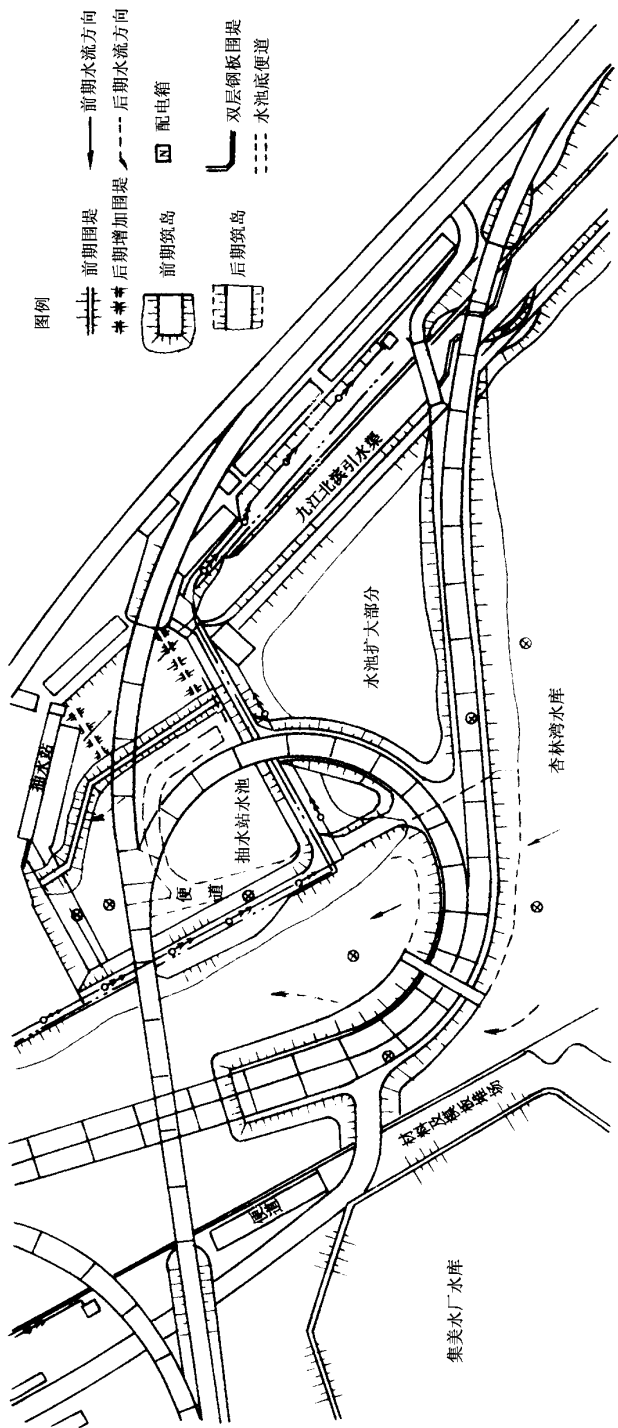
蓄水池围水及杏林湾筑岛施工布置图
